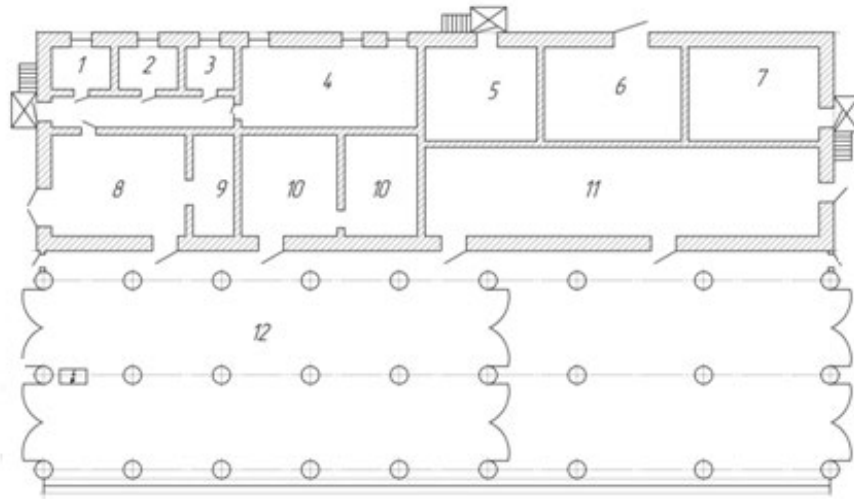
Схема ремонтної майстерні та допоміжної будівлі першого поверху.
